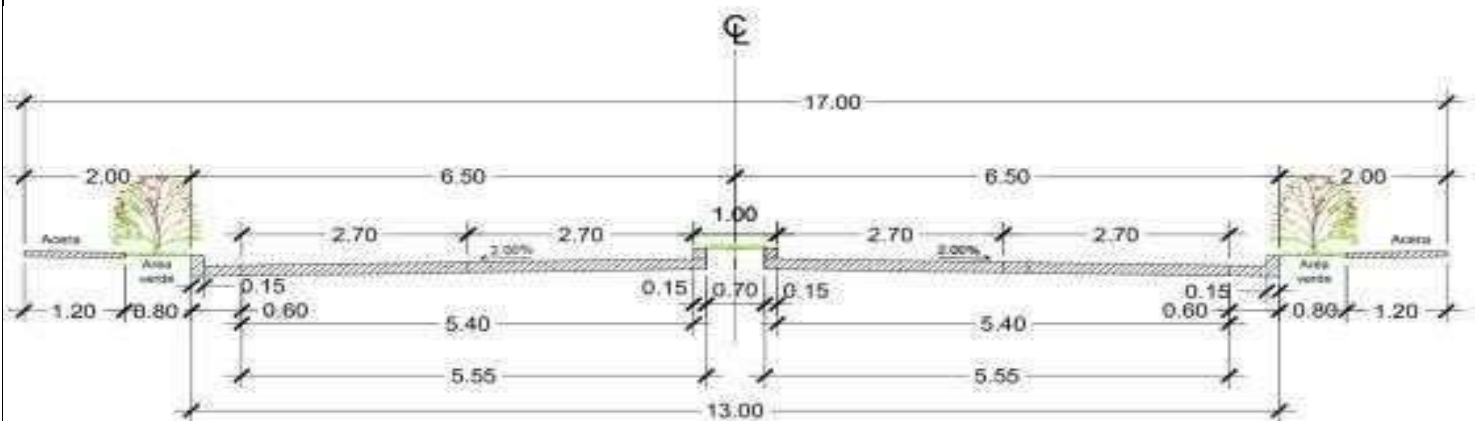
Tomado de: "Análisis del Diseño Estructural de la Superestructura y Subestructura del Puente de Concreto Presforzado en la Villa Los Napoleones" (Amador Martínez & Sevilla Herrera, 2023, p. ~7).
